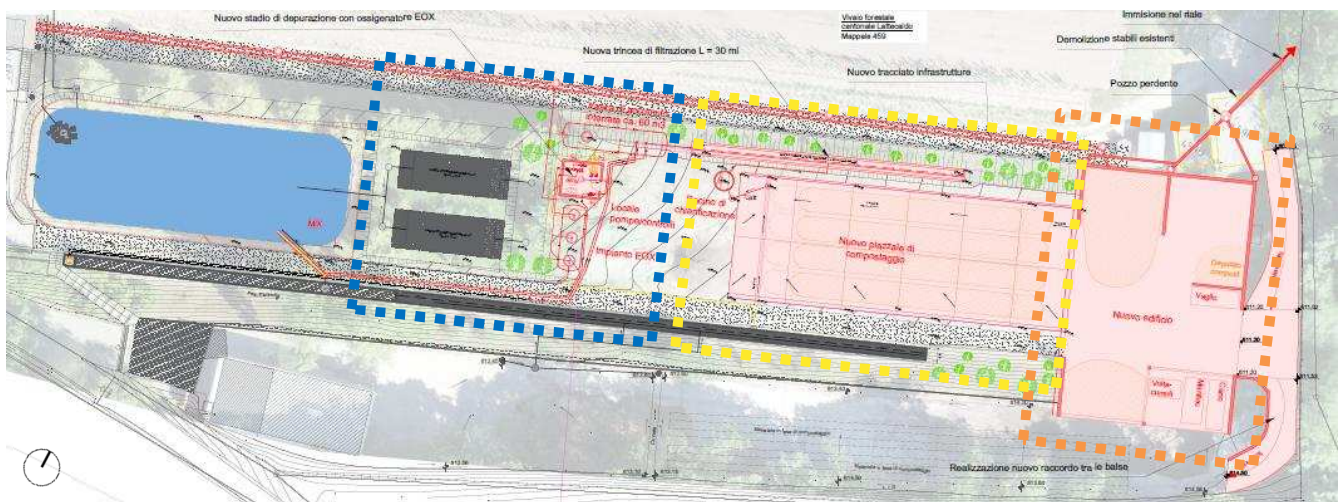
Planimetria generale del progetto suddivisa nei tre elementi principali
